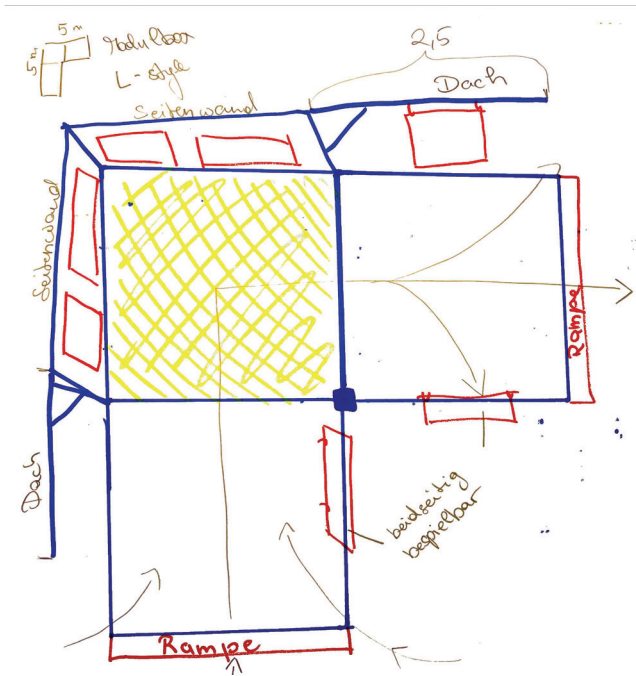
Grundriss-Skizze, Leichtbau Container, Variante 2
